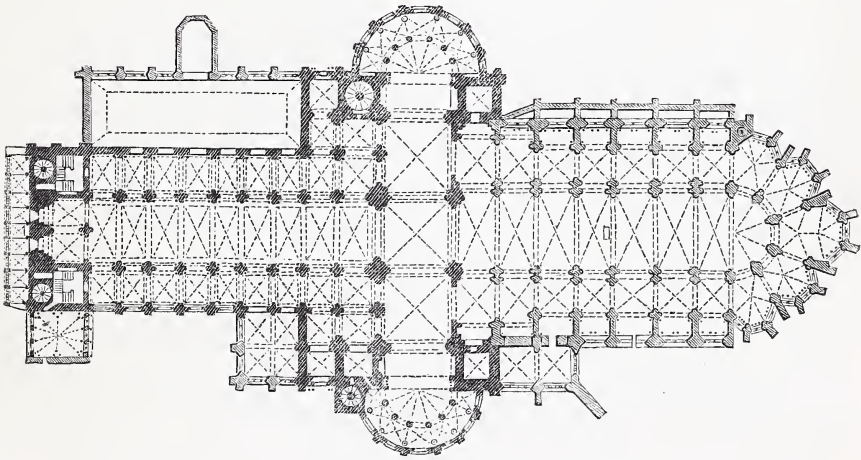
Grundriss der Kathedrale von Tournai.
